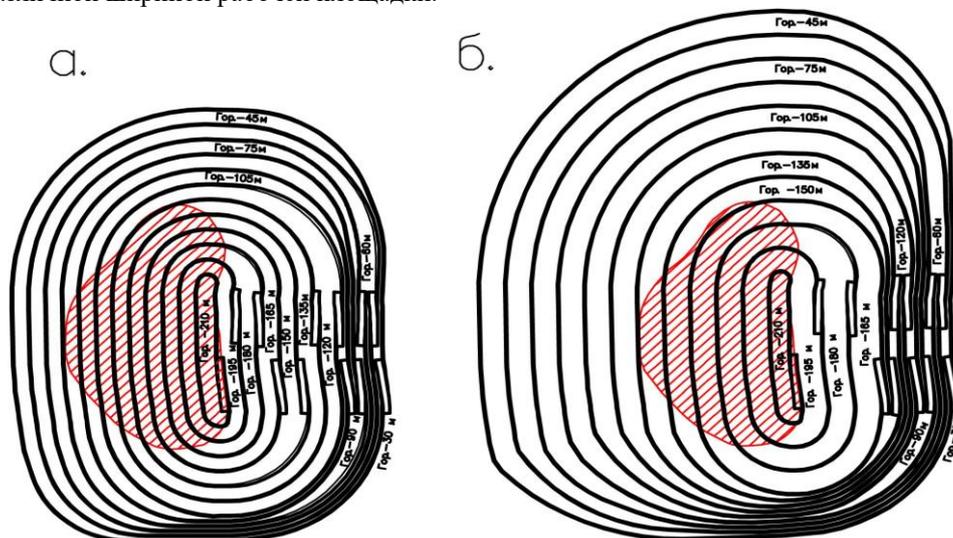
Сводные планы горных работ на момент вскрытия и подготовки гор. –210 м при работе с шириной рабочей площадки: а – 45 м; б – 75 м
